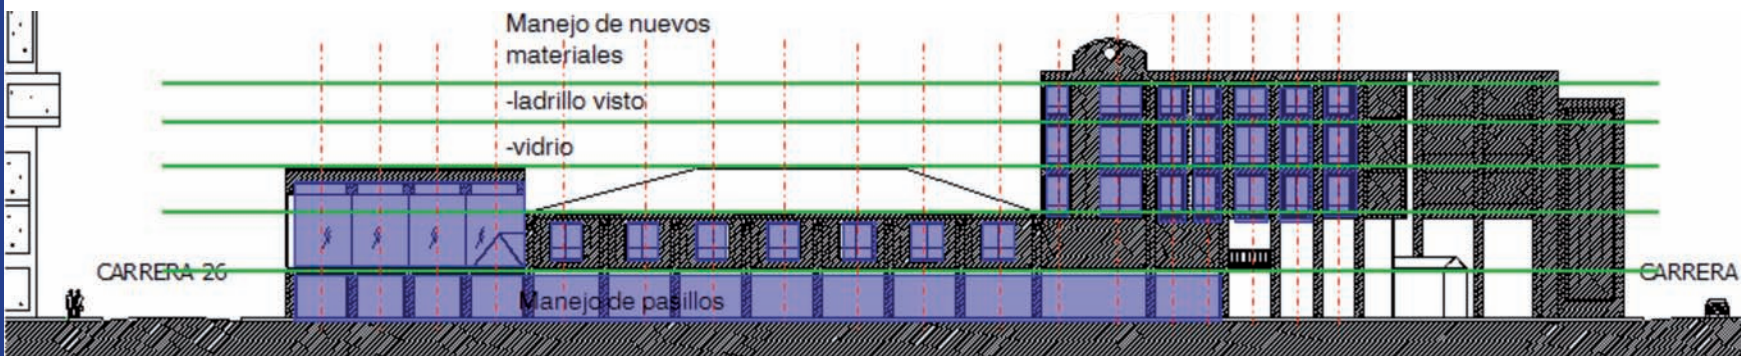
//Levantamiento de fachada, Calle 19 entre carreras 26 y 25 - área de estudio//
